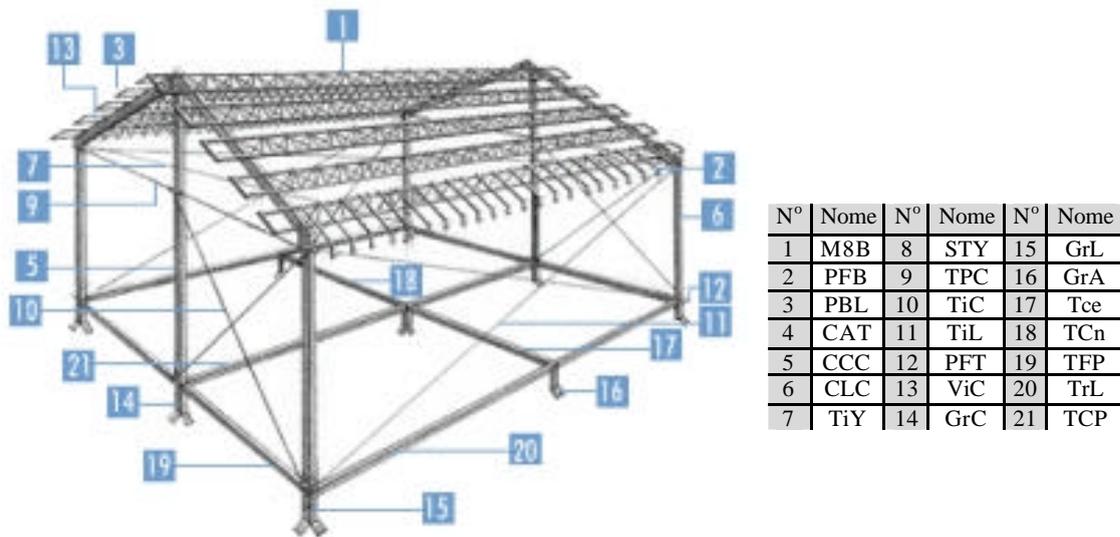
Sistema estrutural com as peças do “Kit” Casa Fácil Gerdau. Fonte: GERDAU (2004)
